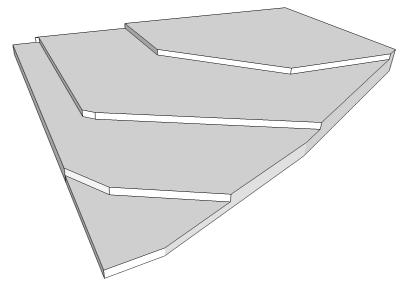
Perspectiva do levantamento planialtimétrico. Fonte: AUTORA, 2019.
